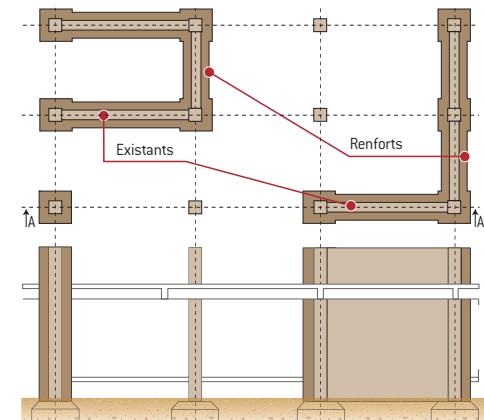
Exemple de renforcement de poteaux, murs, par chemisage en béton projeté [vue en plan et coupe AA]
